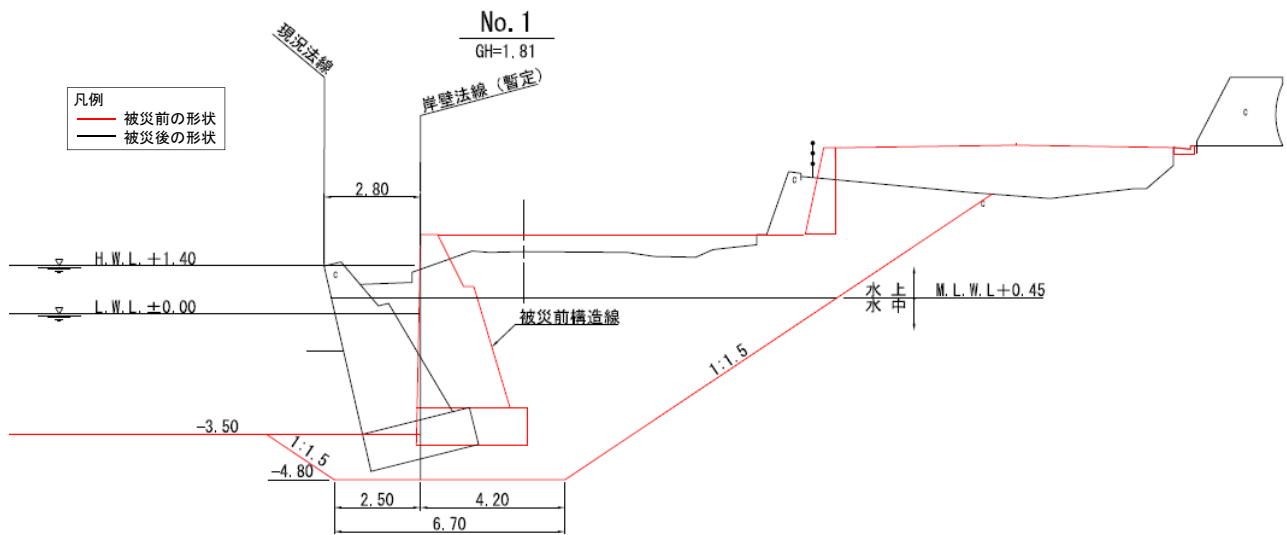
No. 5 海浜第 1 期正面護岸の断面図 No. 1 (被災後)
